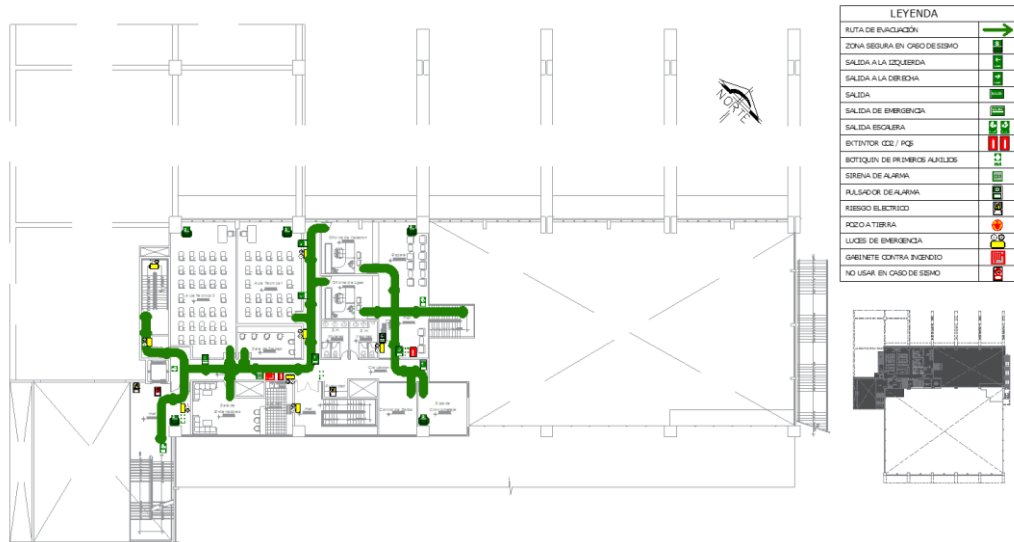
Centro de Masificación Deportiva – Planta 1/ Sector B
